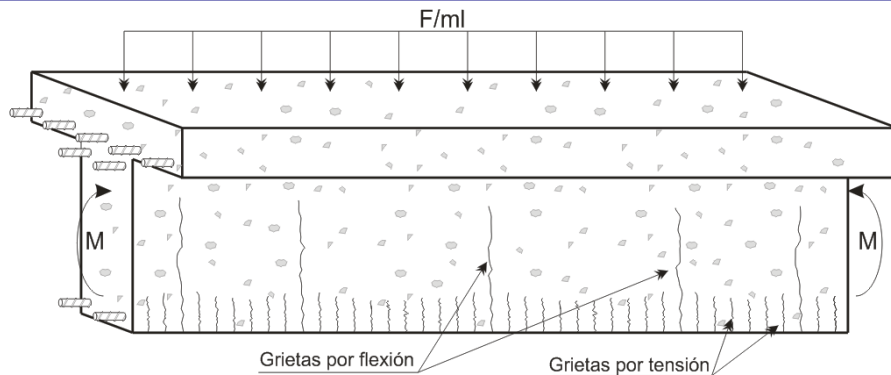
Grietas por flexión y tensión en un elemento sometido a esfuerzos de flexión.
